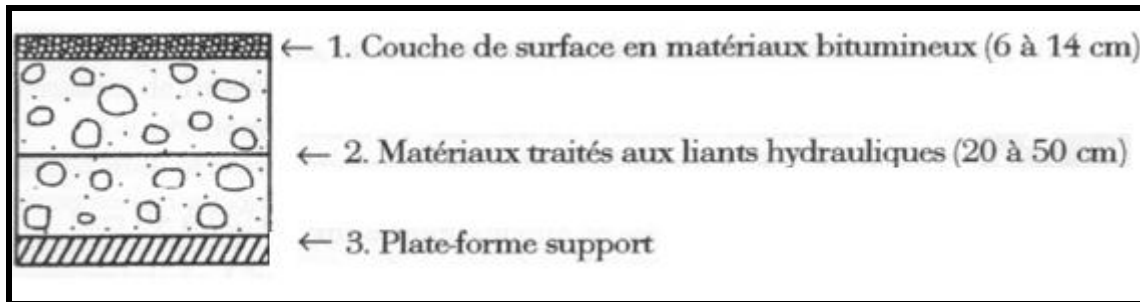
Chaussée à assise traitée aux liants hydrauliques [Catalogue des chaussées, 1998]
